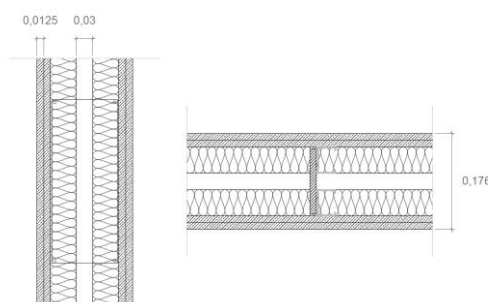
parede divisória dupla em estrutura leve, com 176 mm de espessura
